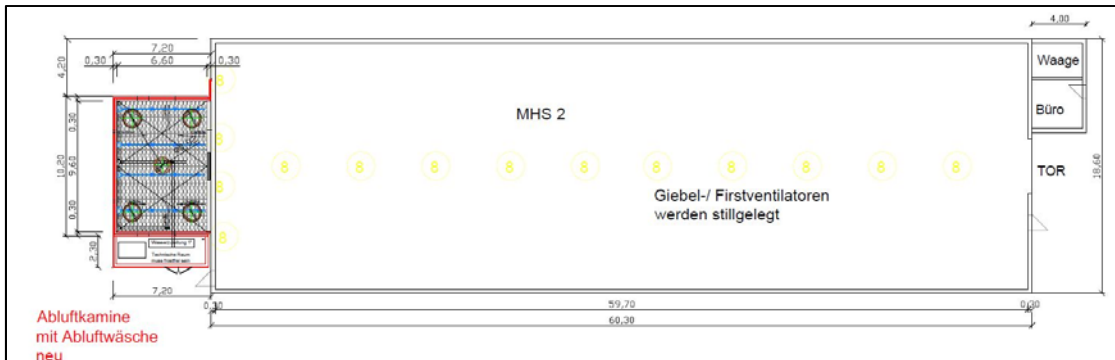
Ausschnitt aus den Planunterlagen, Grundriss MHS 2
